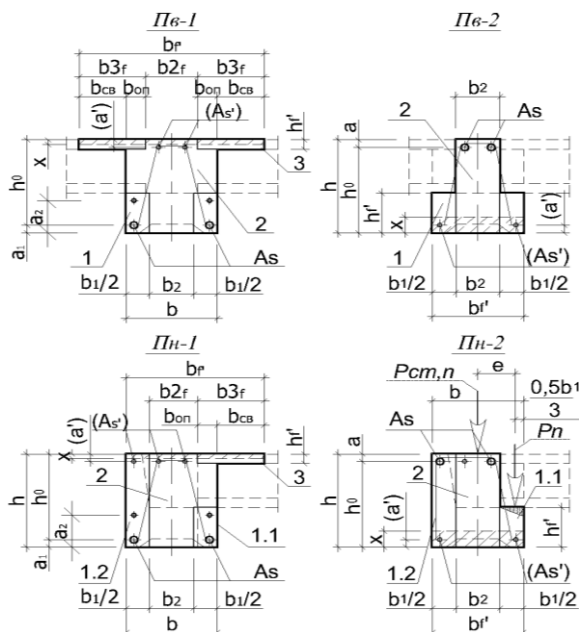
Расчетные модели сечения *АС СбМт* поясов: - внутренних и наружных стен в пролете (*Пв-1* и *Пн-1*) и над опорой (*Пв-2* и *Пн-2*); 1 и 1.1 – опорная ветвь сборного блока; 1.2 – тоже ограждающая; 2 – монолитный бетон; 3 – сжатая полка перекрытия. [Разработка автора].
